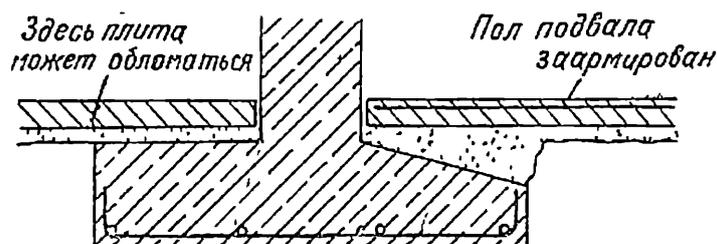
5. Устройство плит полов по ленточным фундаментам
